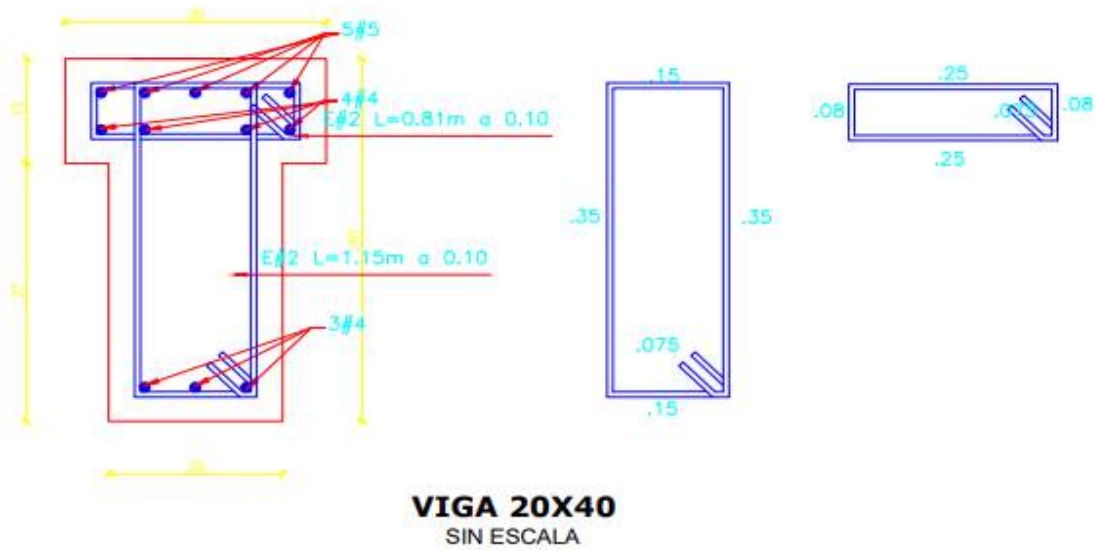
Detalle Viga T 20x40 (Construca, 2021)
